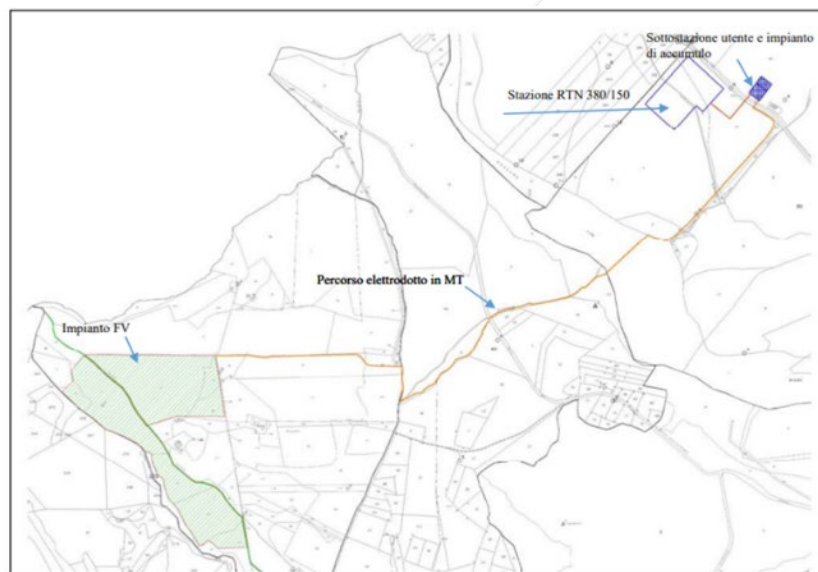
Planimetria generale con percorso elettrodotto in arancio
